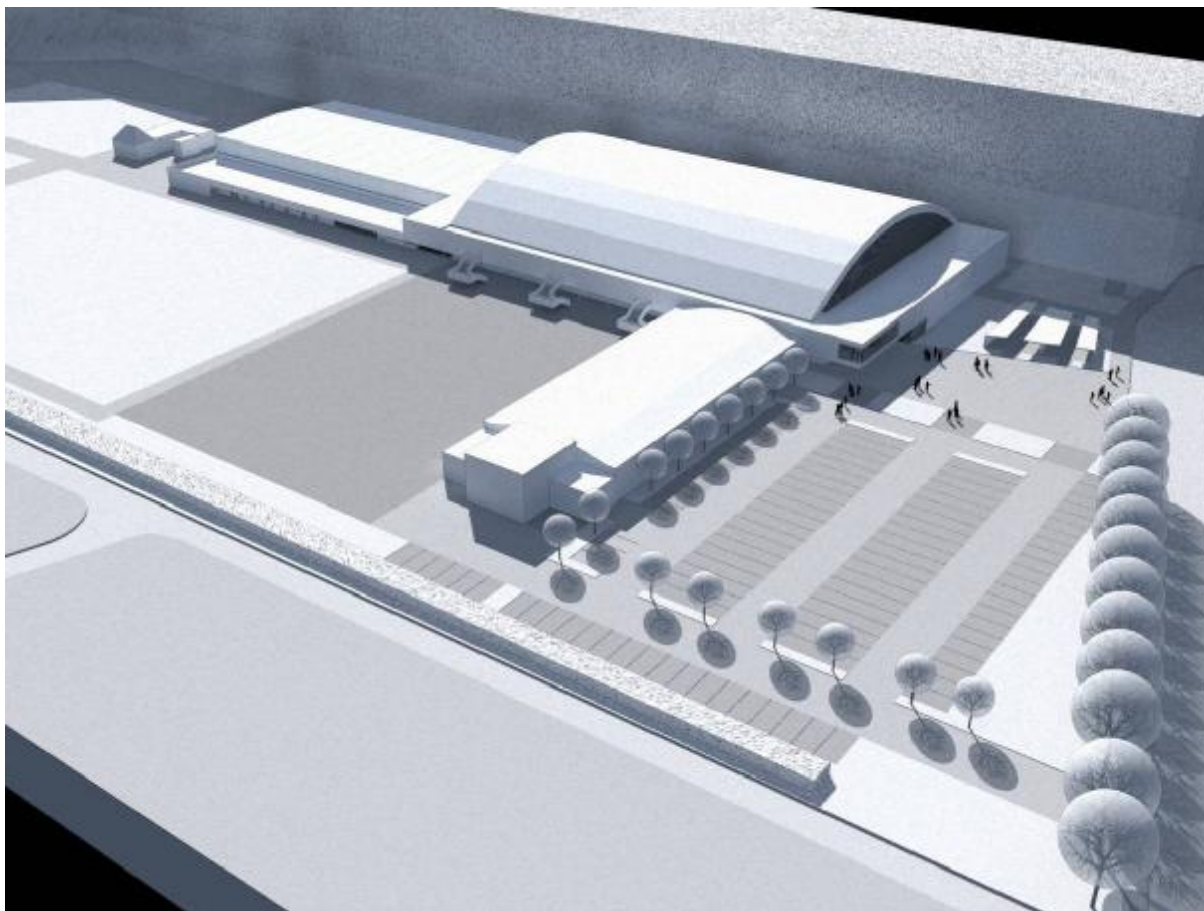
Modellfoto: Im Vordergrund die Curlinghalle, oben links das neue gedeckte Ausseneisfeld
